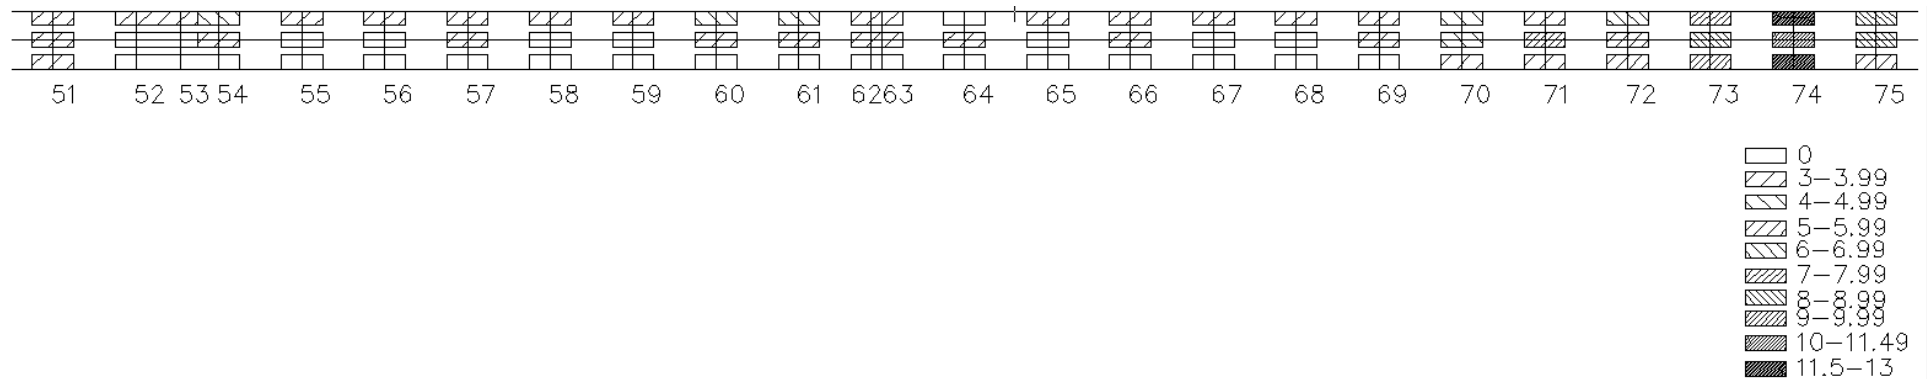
Ausgleichsdicken bei Tangenten und quadratischen Parabeln und Verfahrensplan Typ V, Grundriss, Stationen 51-75
